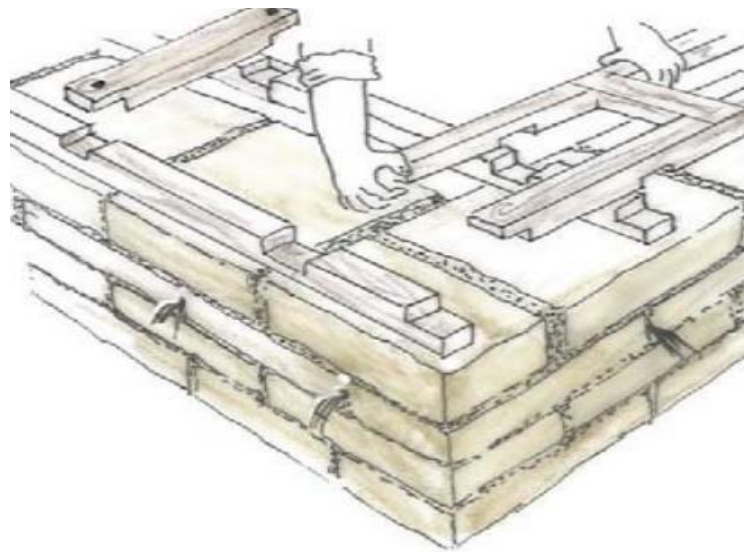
Ejemplo esquemático de un tipo de Viga Collar
